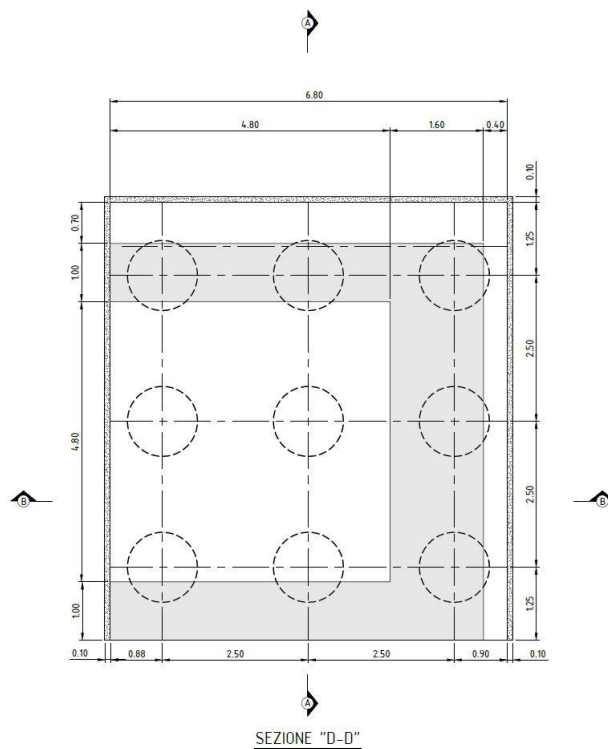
Vista in pianta della spalla (estradosso della platea di fondazione)
